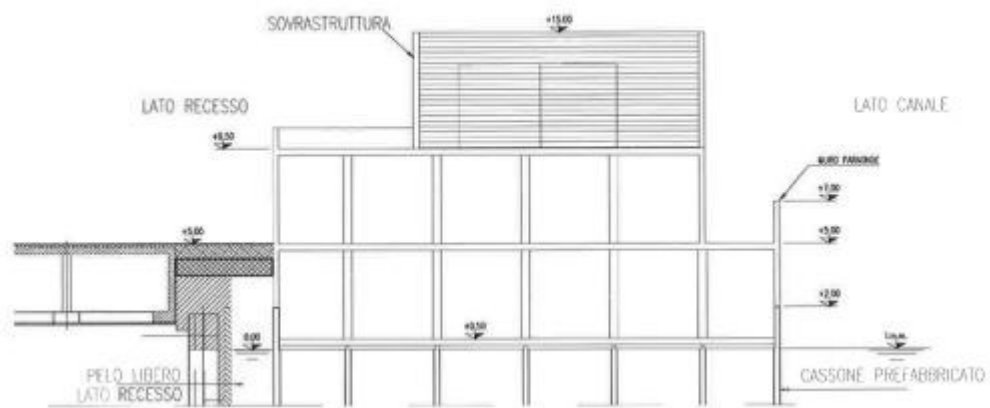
Sezione del cassone di spalla Ovest con sovrastuttura; estratto dagli elaborati grafici AS BUILT.
